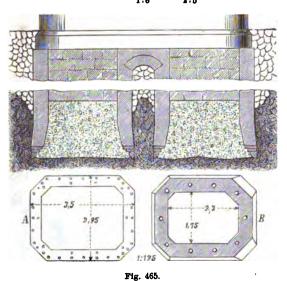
zeigt die Betonirung und Ausmauerung der Senkbrunnen, worauf ein Pfeiler der Fussgängerbrücke über die Saale zu Weissenfels fundirt wurde und wobei die Betonlage 2<sup>m</sup> Höhe erhielt. Der Grundriss der Brunnenkränze, deren Querschnitt Fig. 465 zeigt, ist bei A dargestellt, während bei B ein Horizontalschnitt des Brunnens gegeben ist, woraus hervorgeht, dass jeder Brunnen 10 Stück verticale Ankerbolzen erhalten hat. Oben sind beide Brunnen des Pfeilers durch ein Gewölbe mit einander verbunden.
